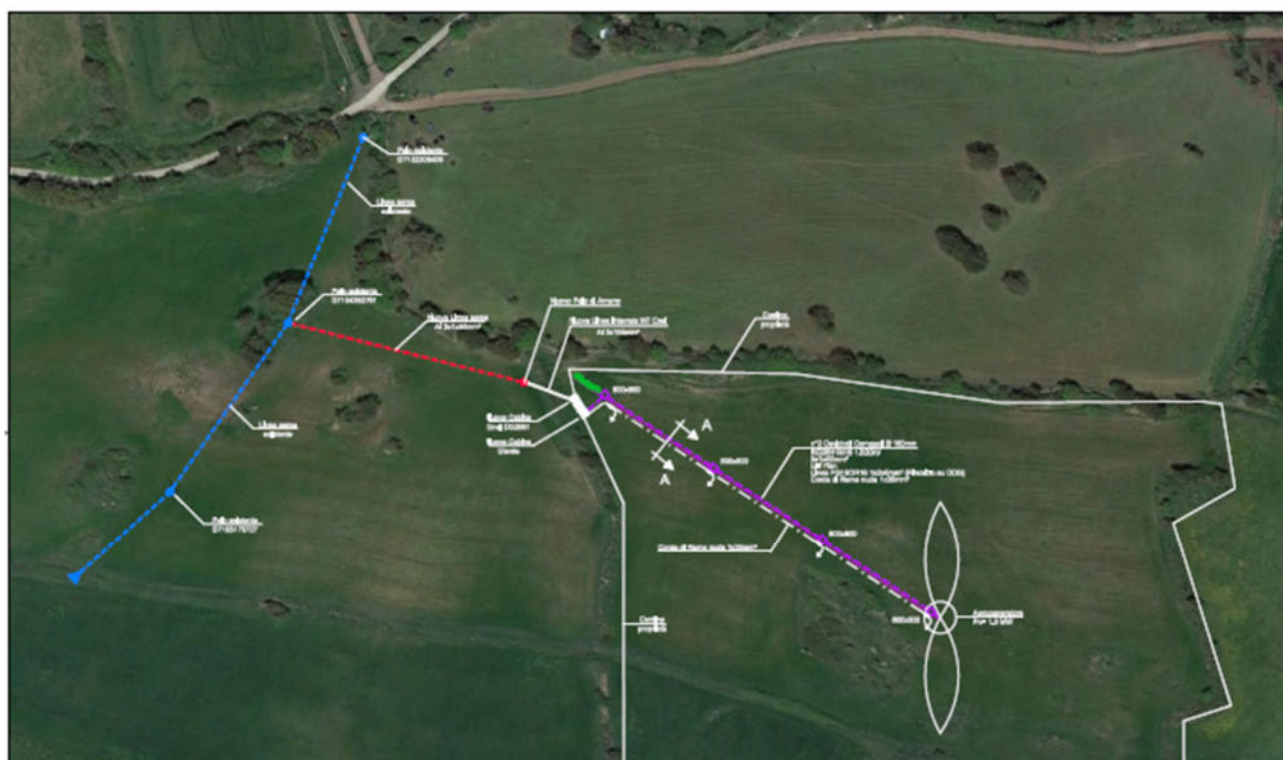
LAYOUT DI PROGETTO INSERITO SU ORTOFOTO
